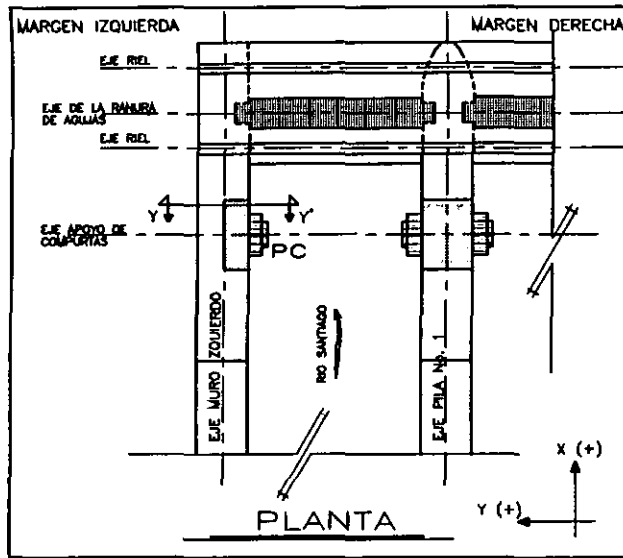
Deformimetros instalados en el acero de refuerzo, pila No. 1 del vertedor
